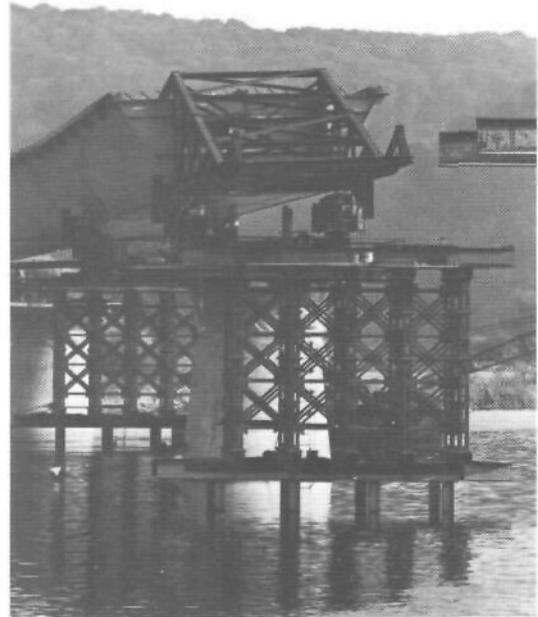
Fondations réalisées à l'aide de H.E.B. Ces fondations sont à comparer à celles de la photo 87.
